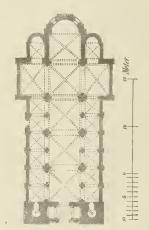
S. Fides zu Schlettstadt. Grundrifs.
